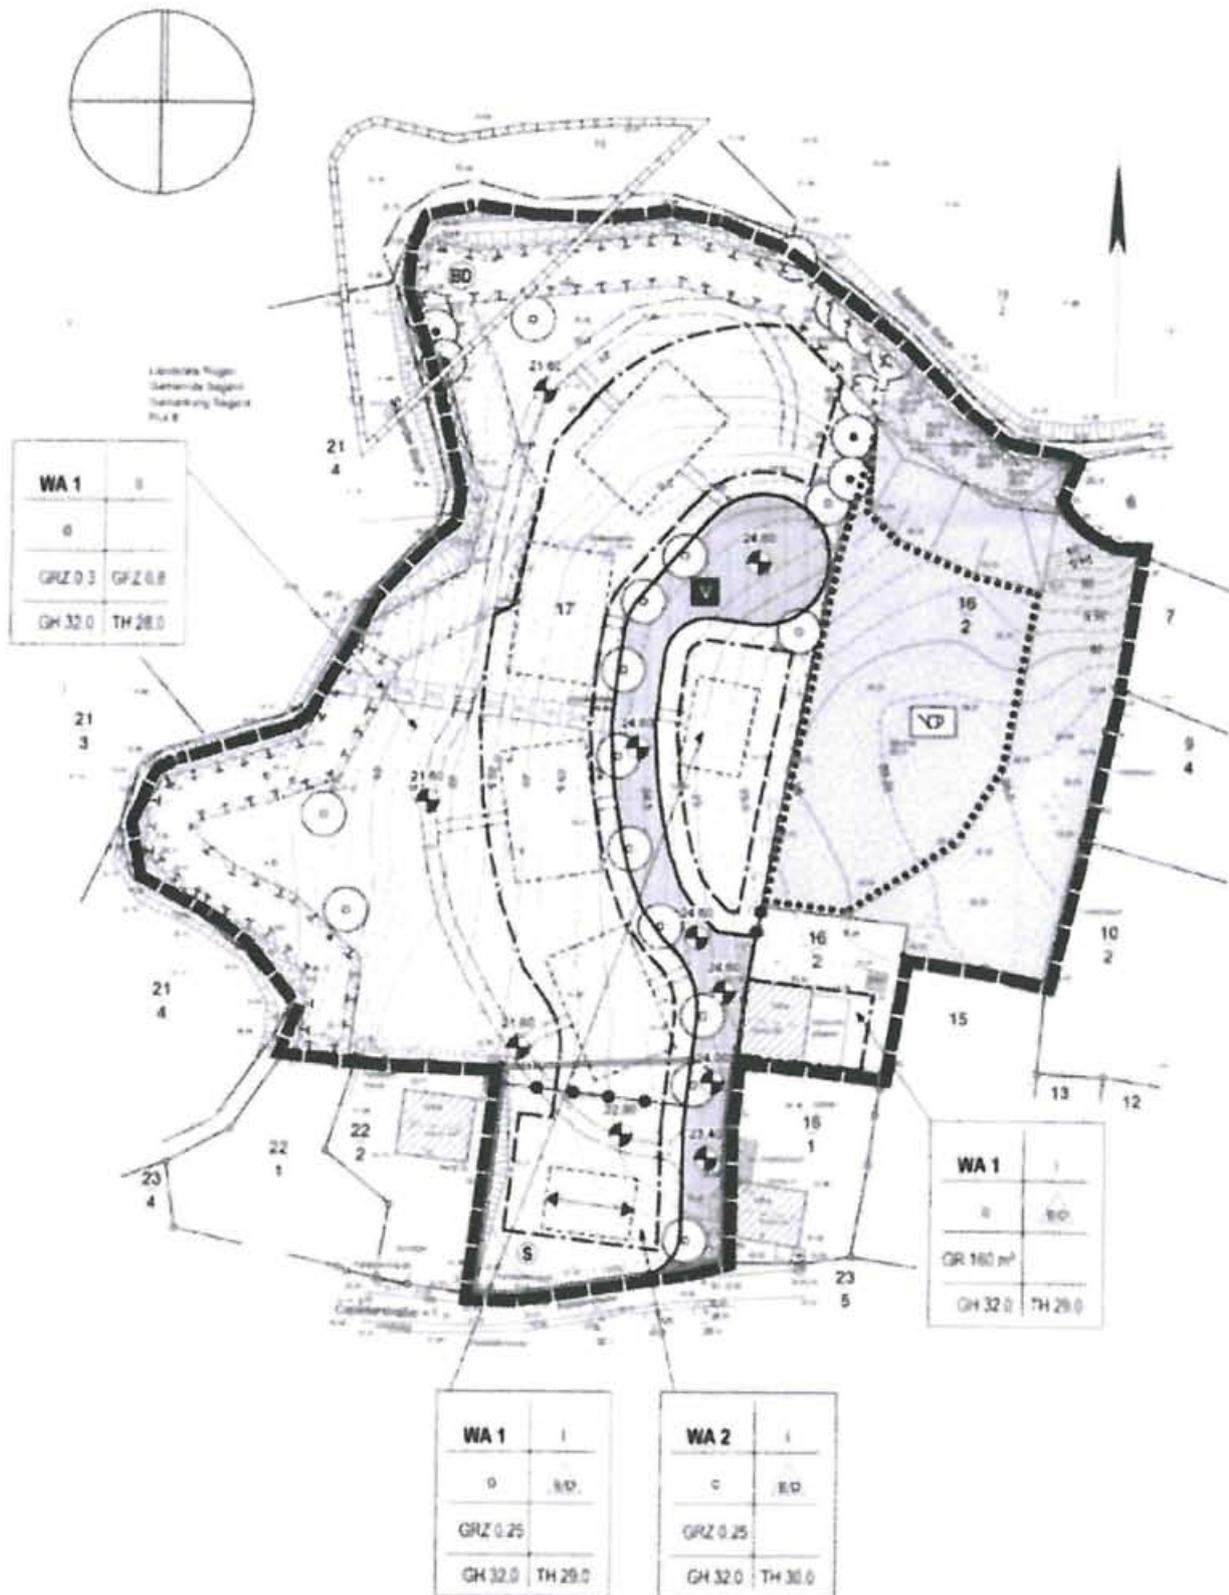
Ursprungsplan, Planzeichnung ohne Maßstab
